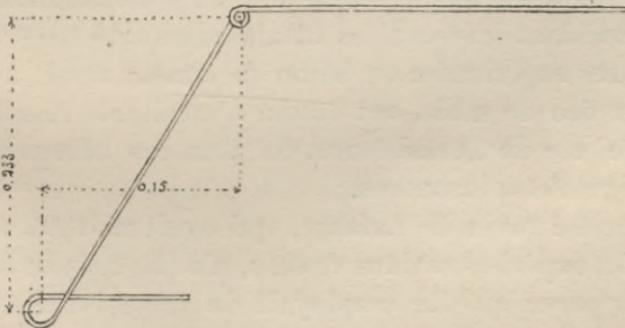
Poutre armée spéciale. Élévation d'une attache.
